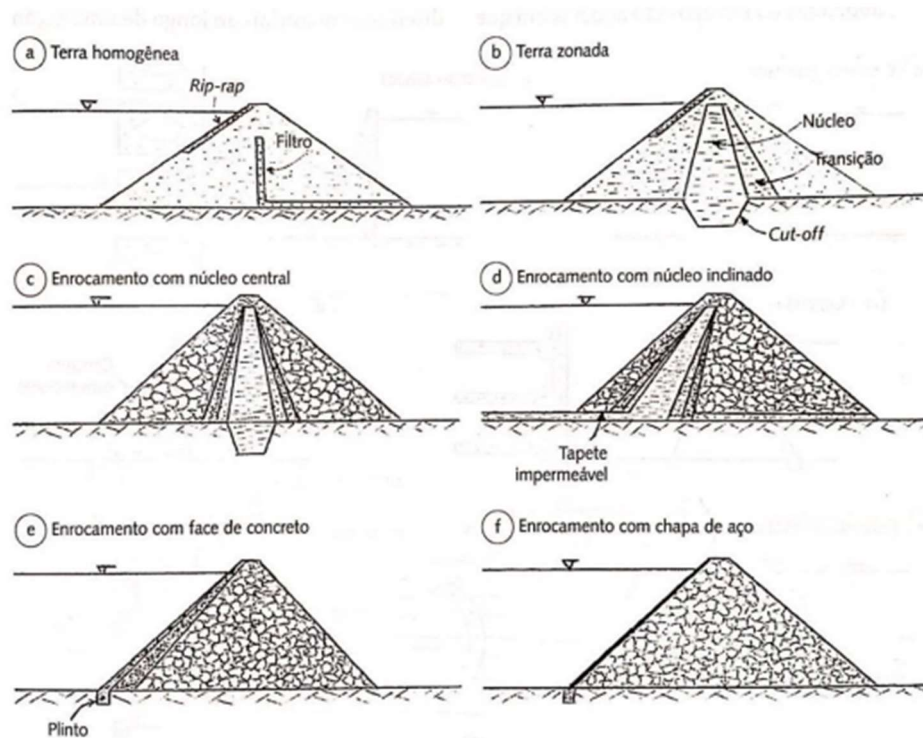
Perfis transversais convencionais de barragens de terra e enrocamento (modificado de Costa, 2012).
